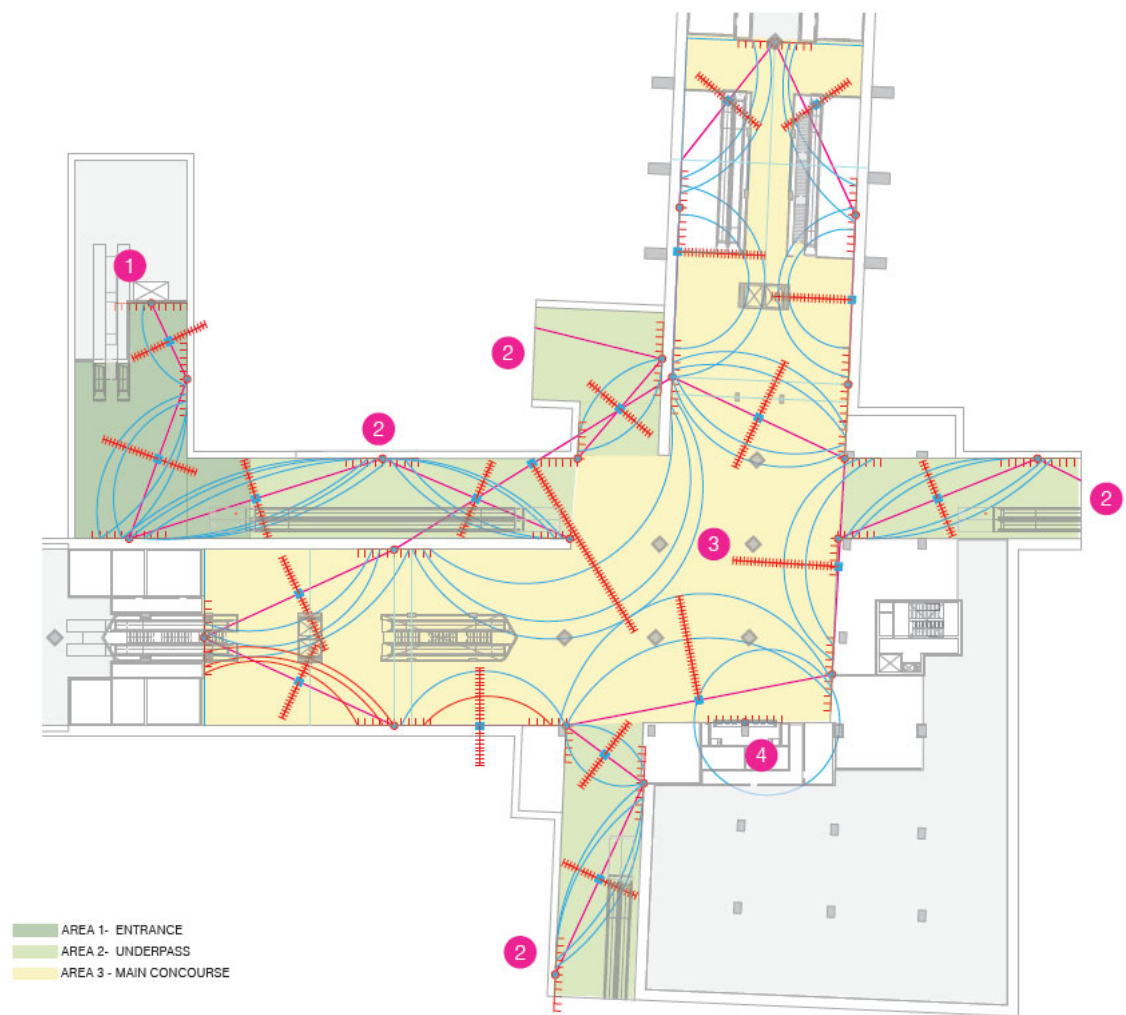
Elemento speciale: geometria e modularità per il disegno del retail wall al livello mezzanino della stazione di Msheireb (fonte ABM)
